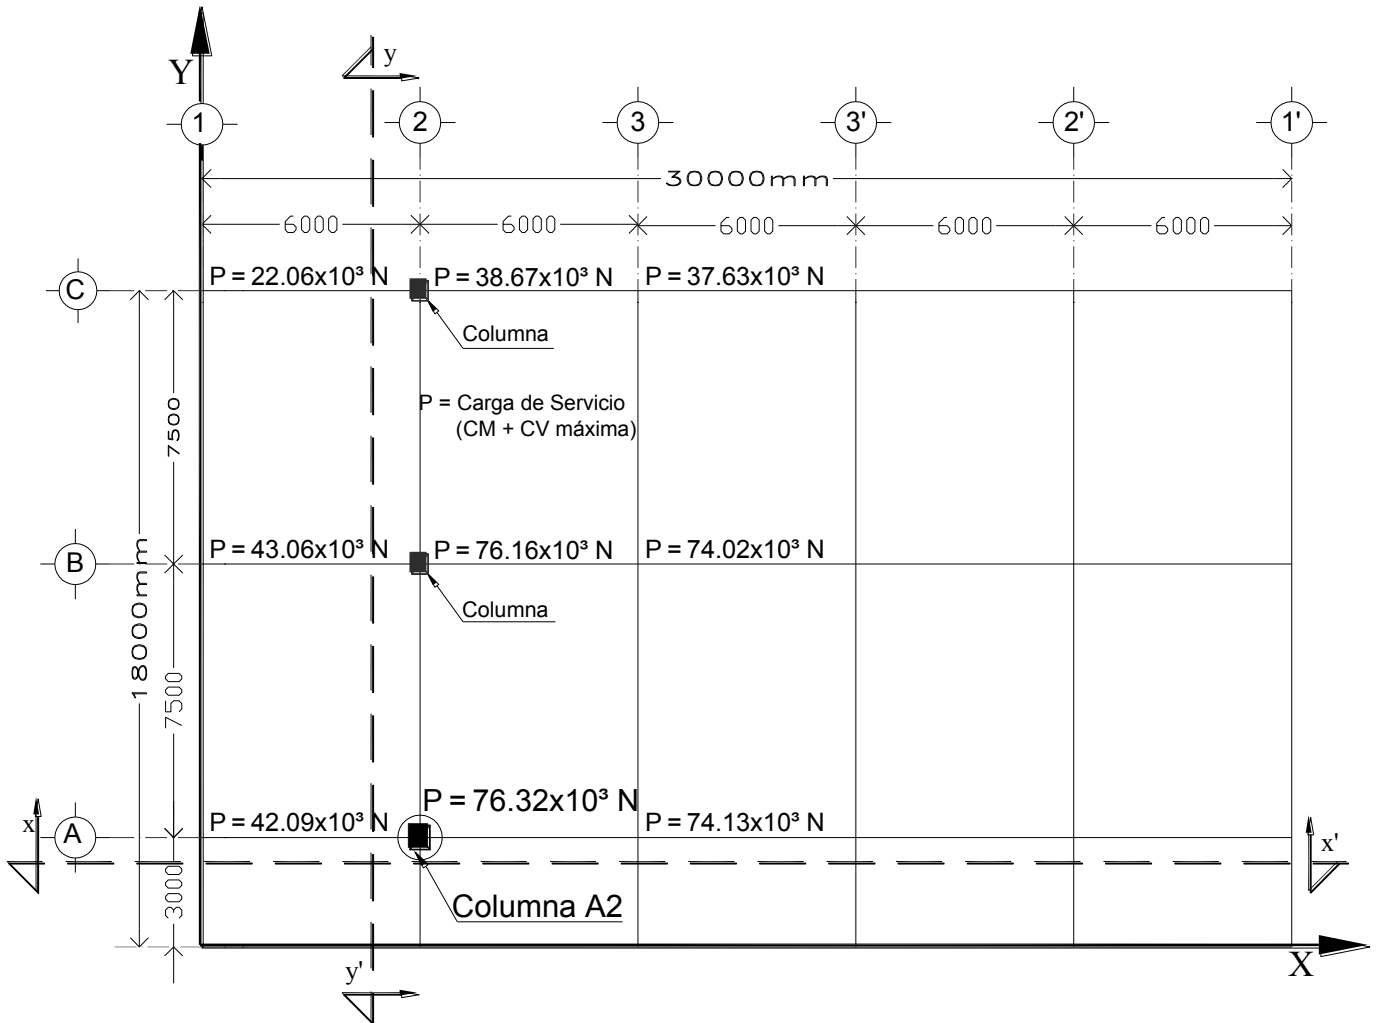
Localización en planta de la columna A2 y del corte longitudinal (x - x') y corte transversal (y - y') del ejemplo 6.1
